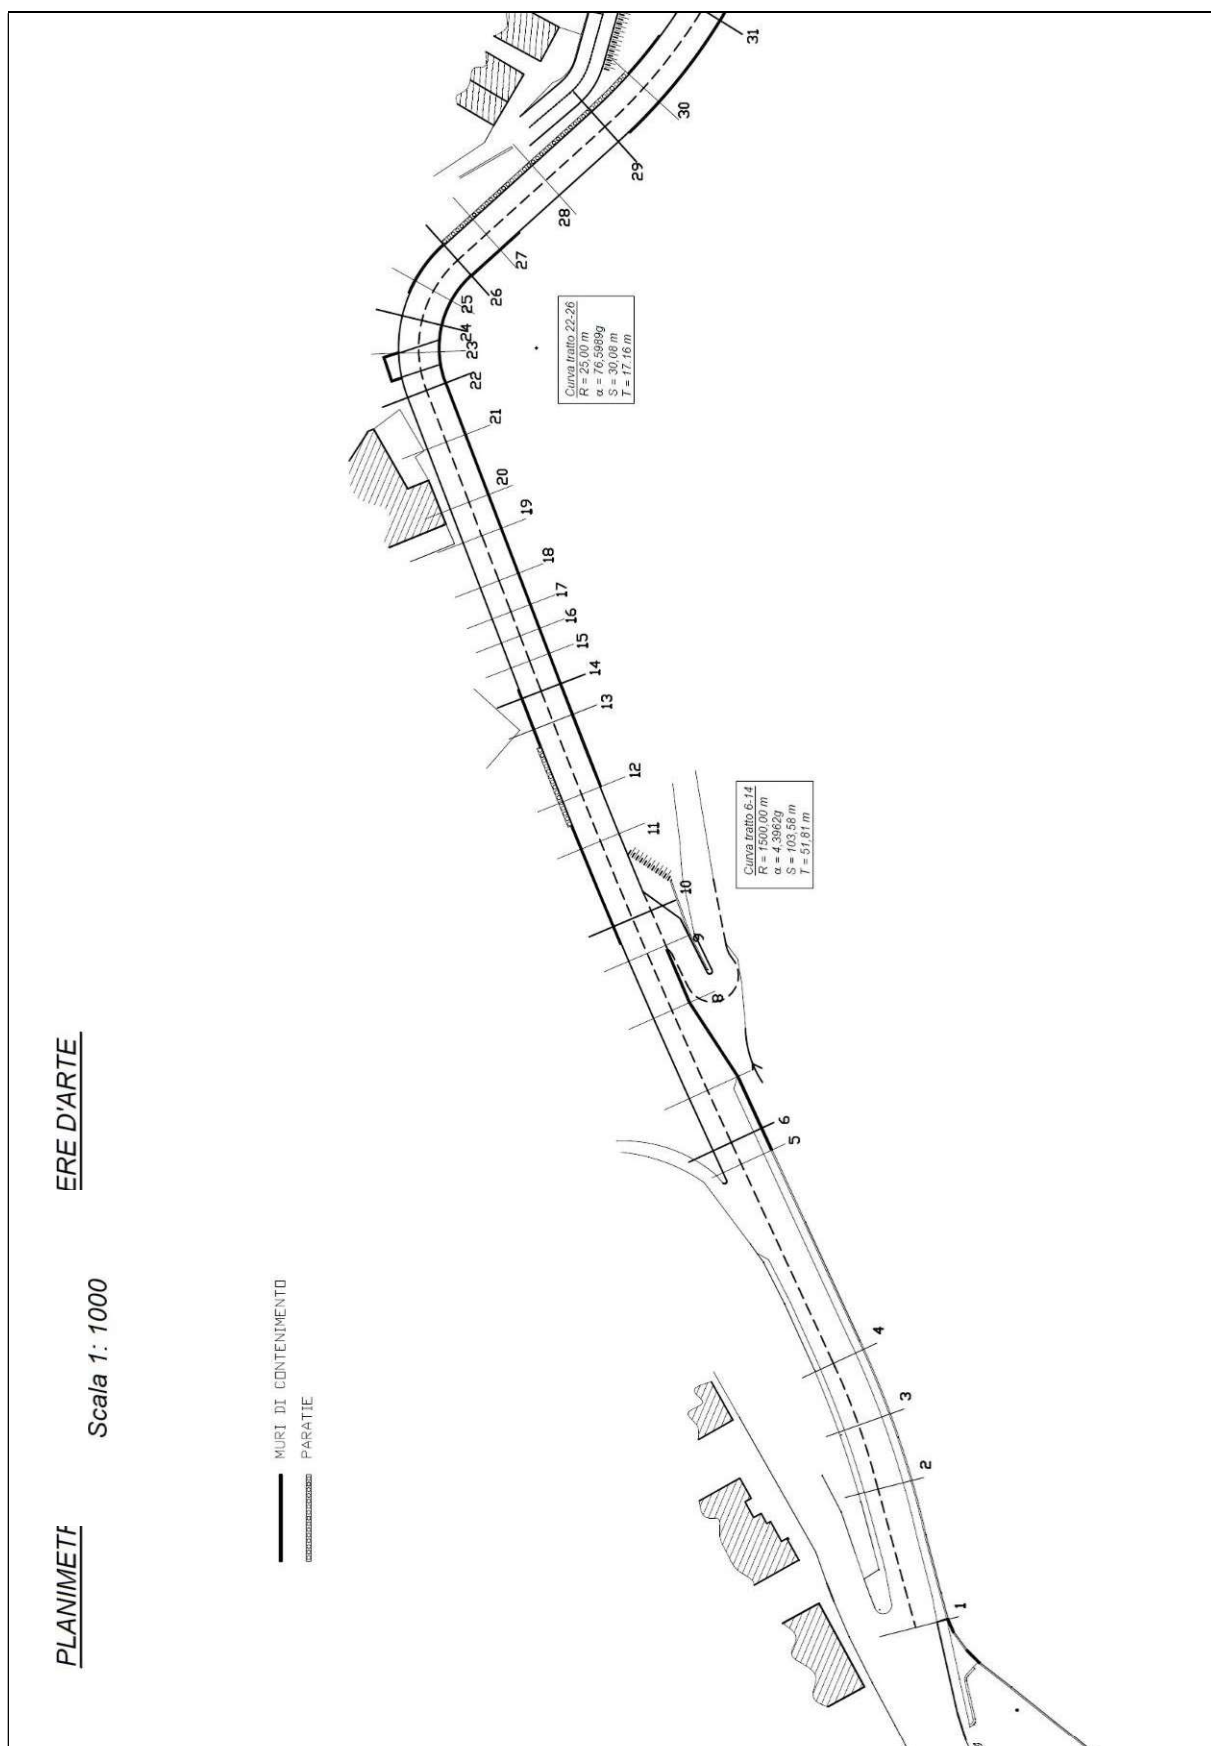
Planimetria del tracciato stradale con ubicazione delle sezioni (dalla n°1 alla n°30).
